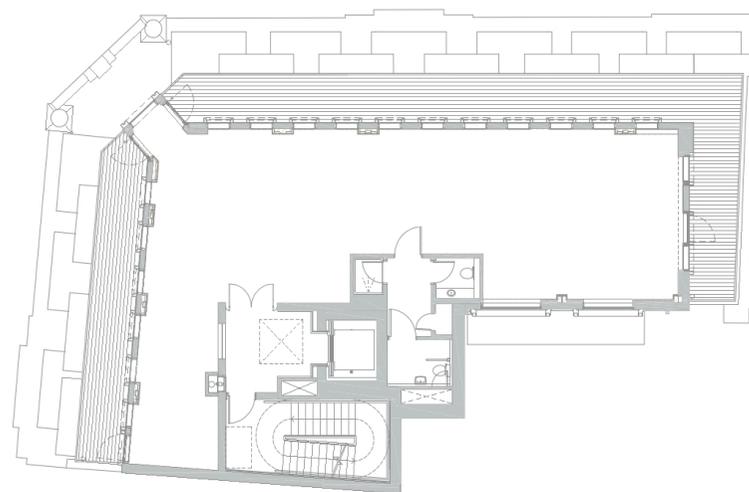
Axtell Soho*, pianta 6° piano.
